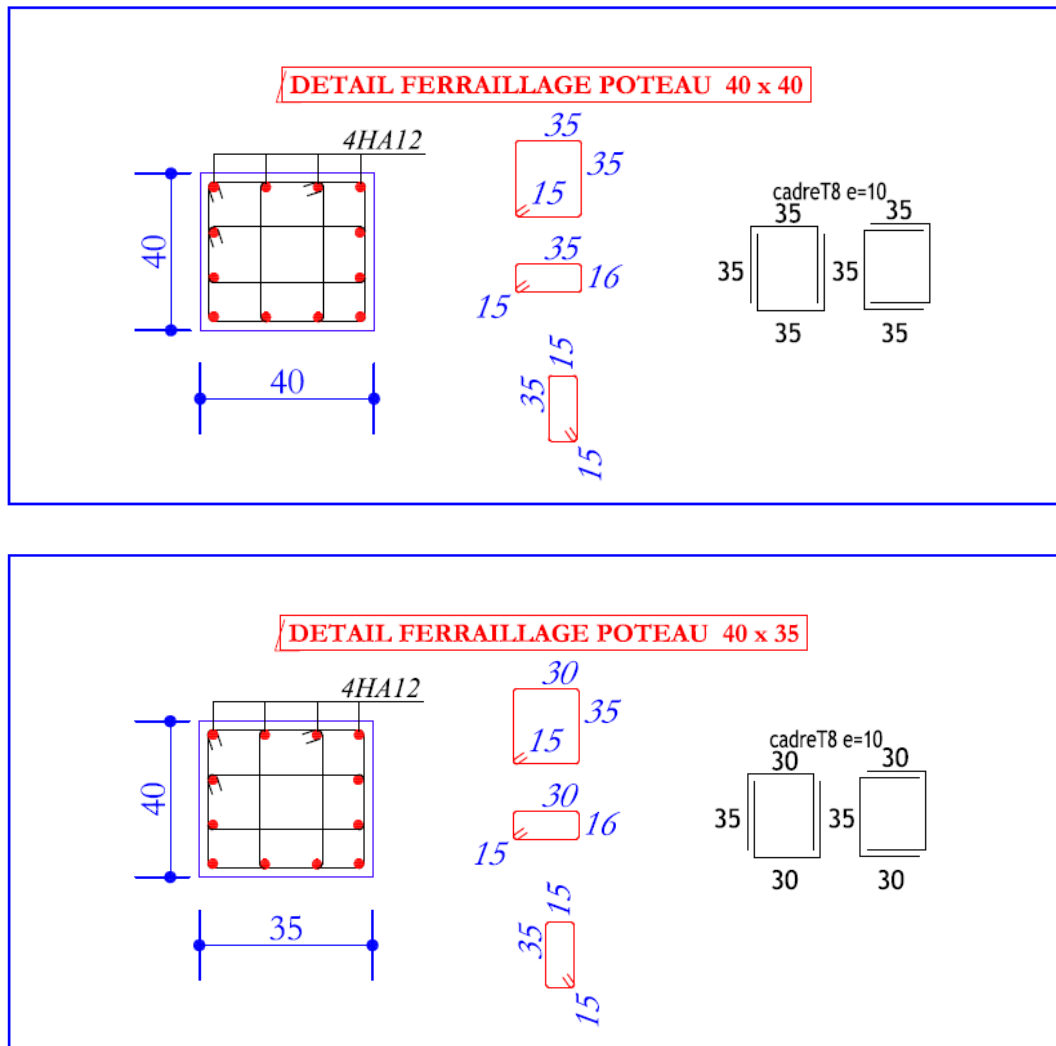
Schéma de ferrailage des poteaux dans les différents étages.
